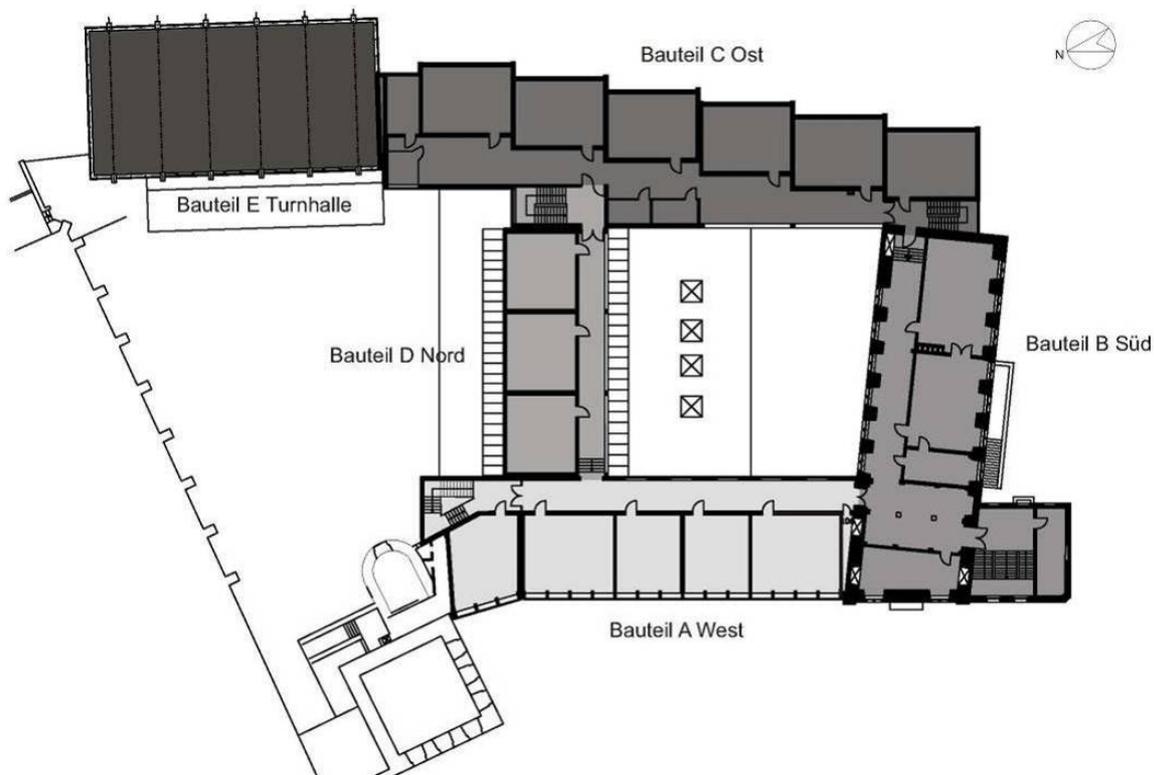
Grundriss 1.OG, Gymnasium Hildesheim
